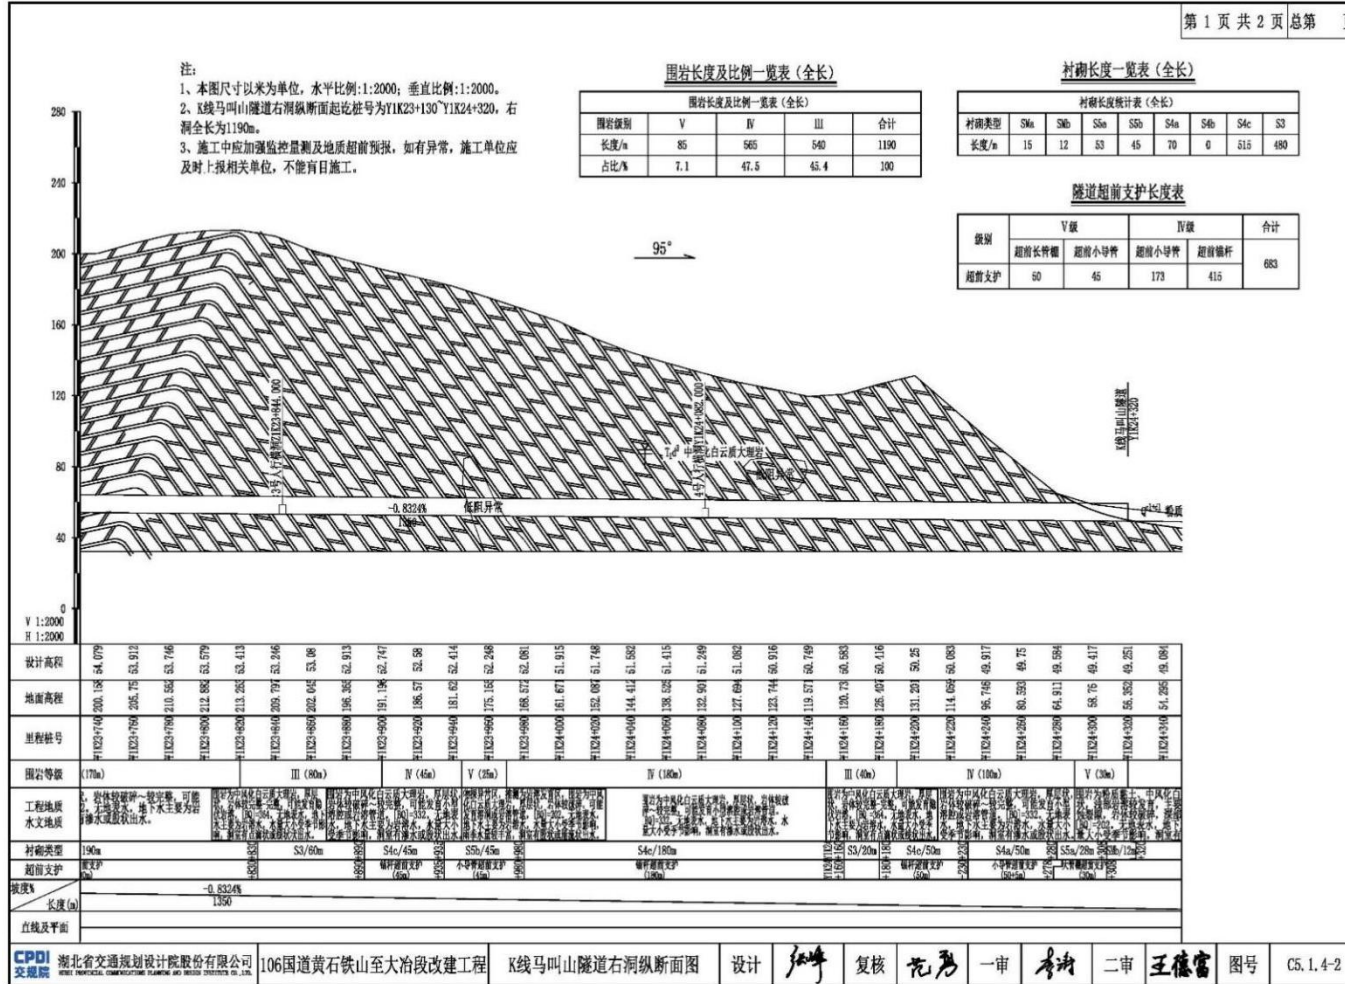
马叫山隧道右洞纵断面图 (二)
